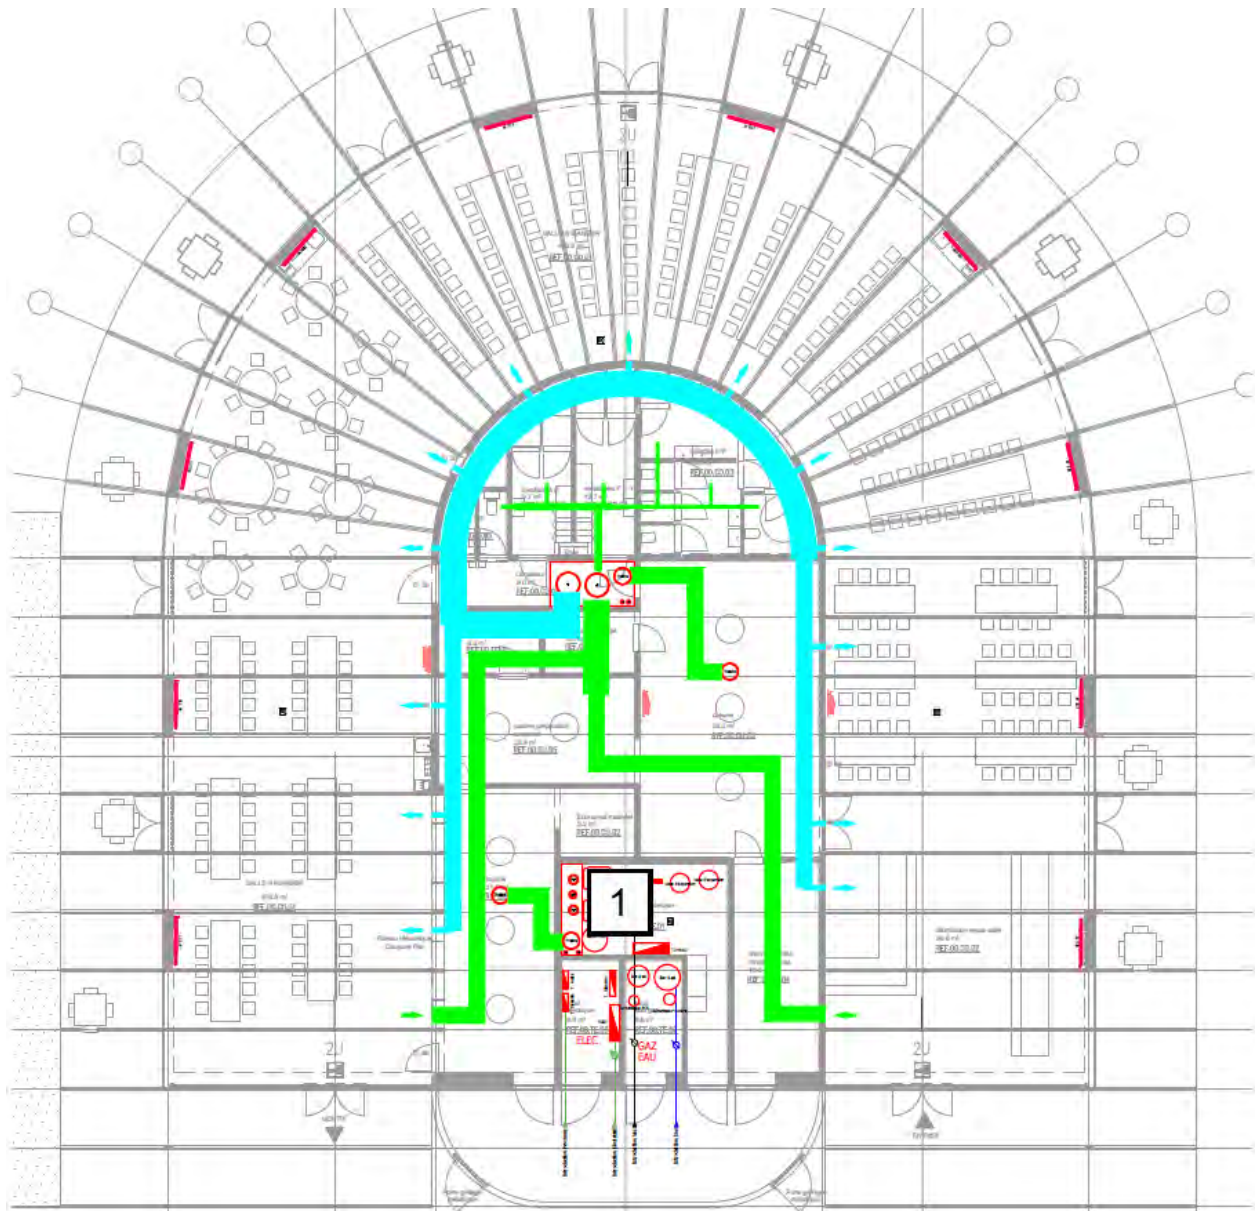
Localisation des installations techniques du bâtiment DOA sous-toiture (MK Engineering, 2018)
